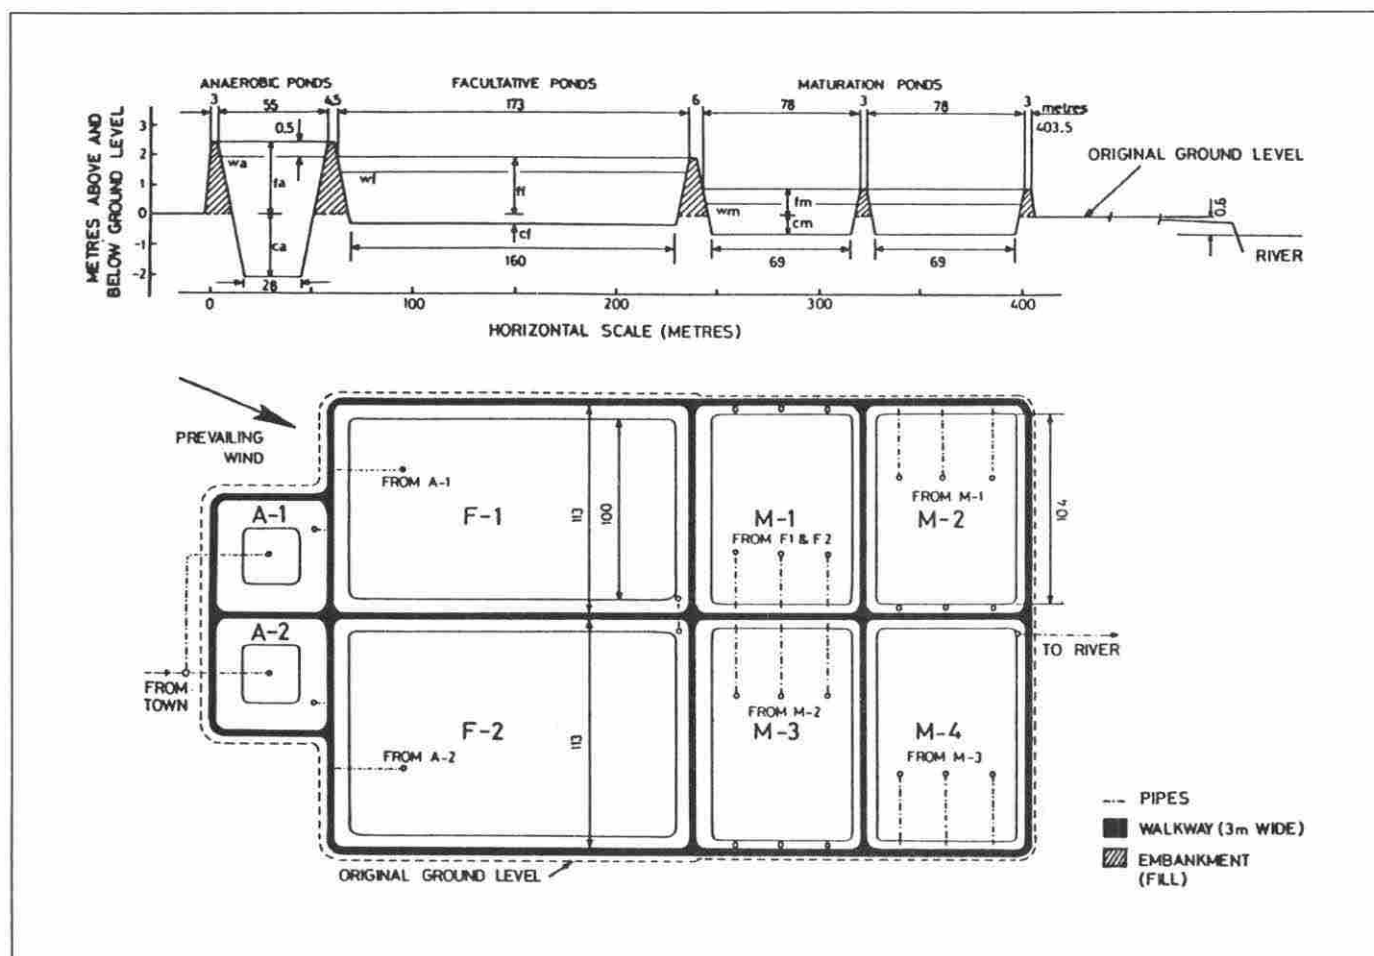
Vue en coupe et en plan d'un système d'épuration. L'échelle verticale est exagérée de 15 fois par rapport à l'échelle horizontale pour mettre en évidence les différents niveaux.
